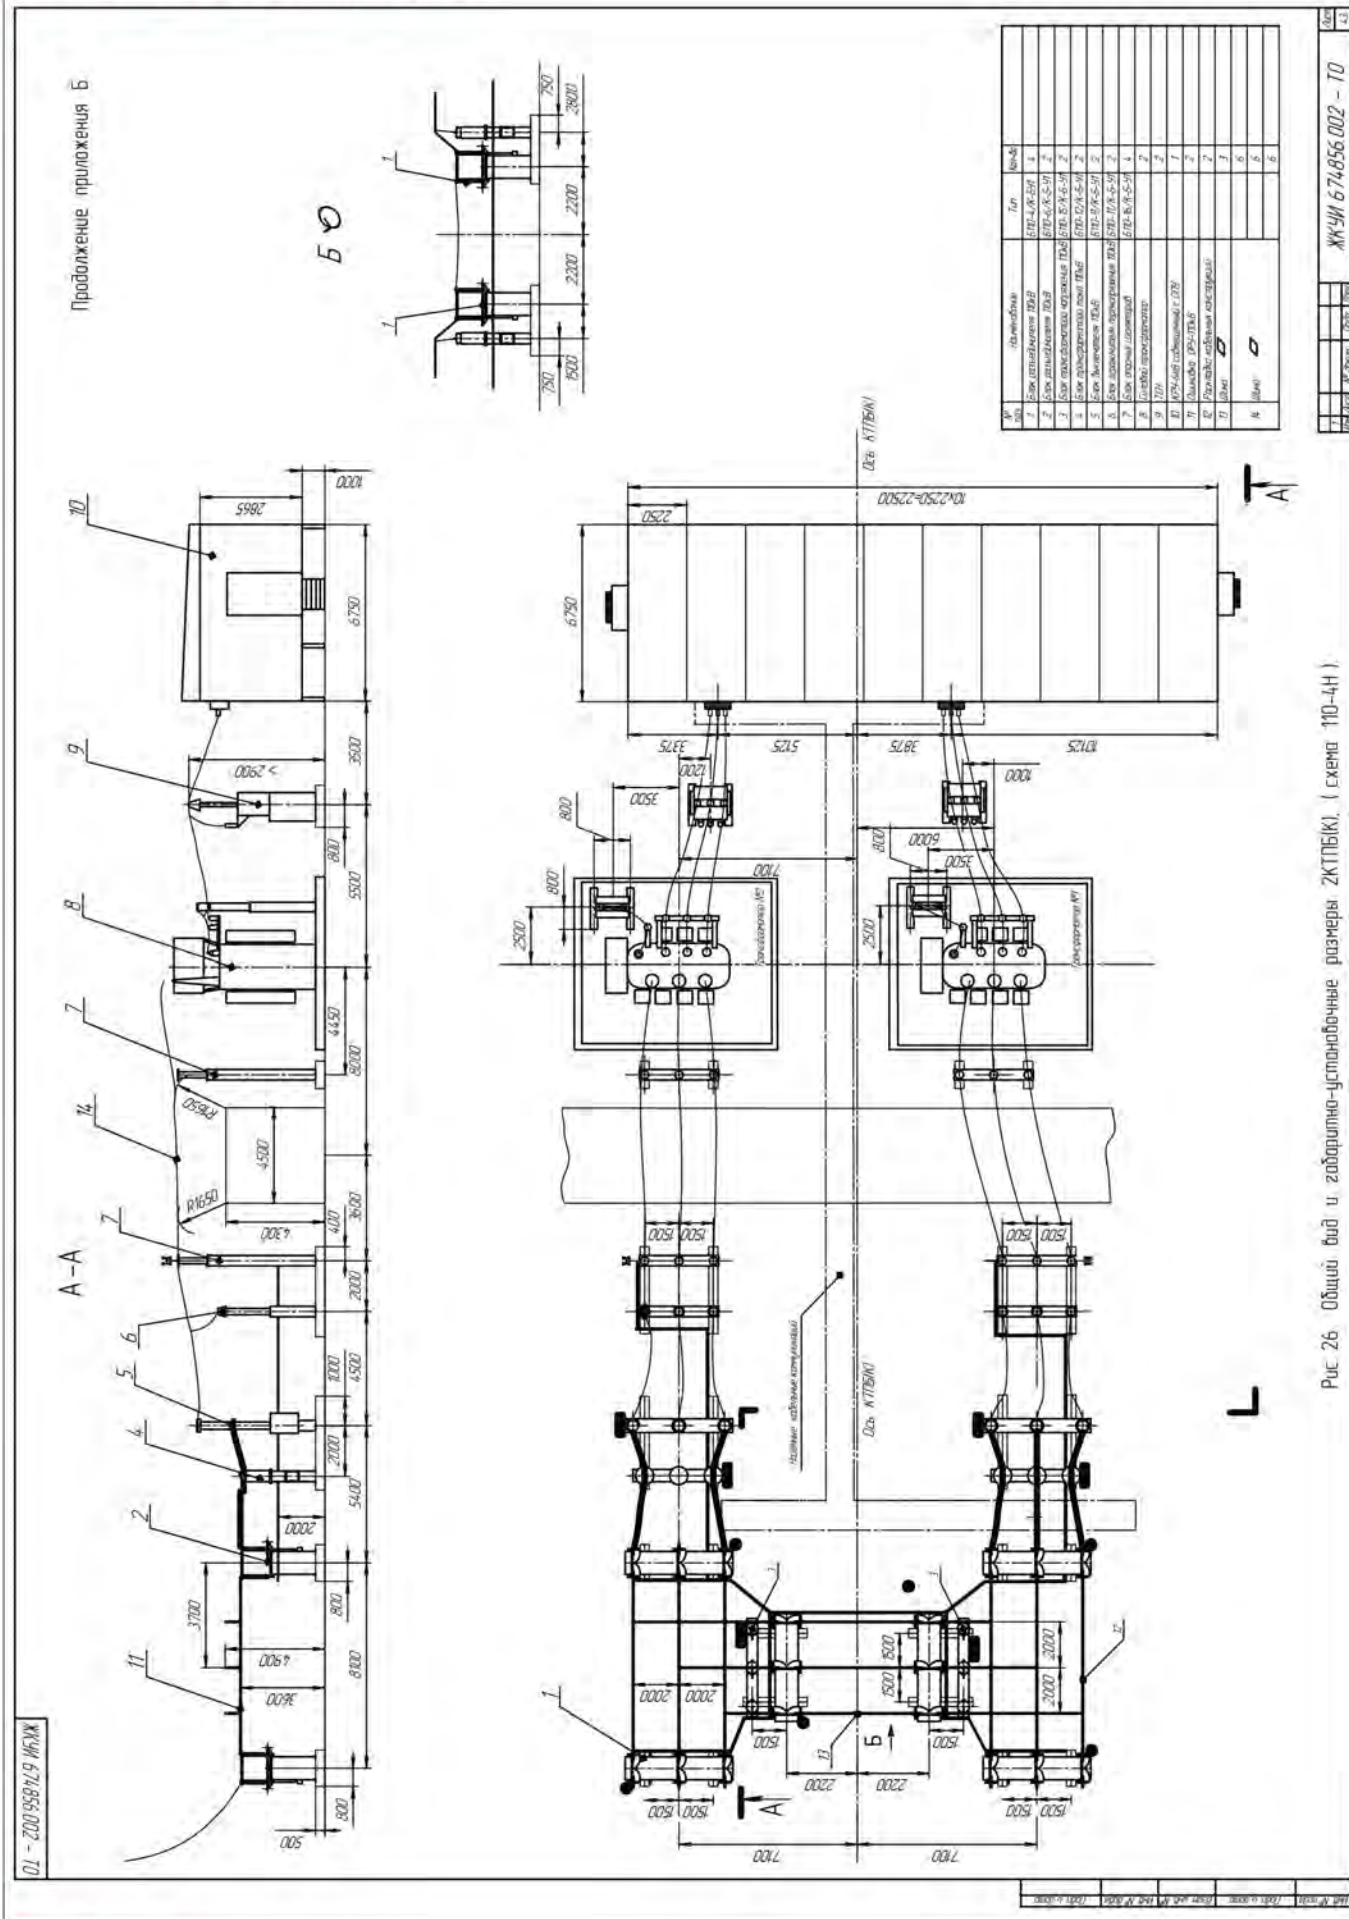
Общий вид и габаритно-установочные размеры 2КТПБ(К). (схема 110-4Н)
